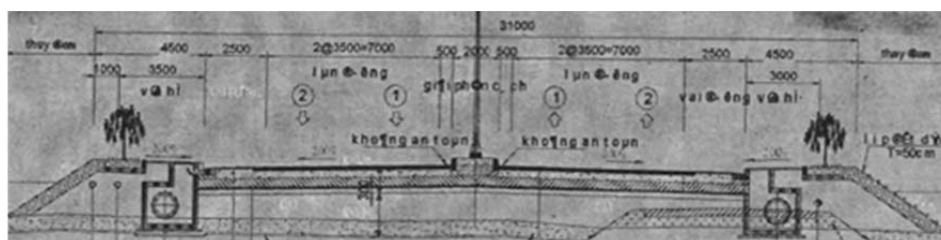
ビエンホア市バイパスの標準横断面図
